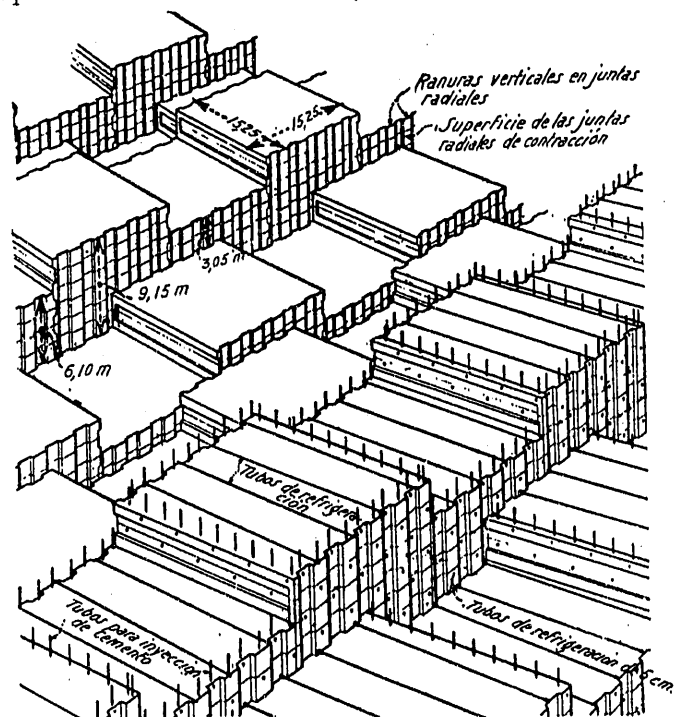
Esquema de los bloques constructivos y de las juntas de contracción
